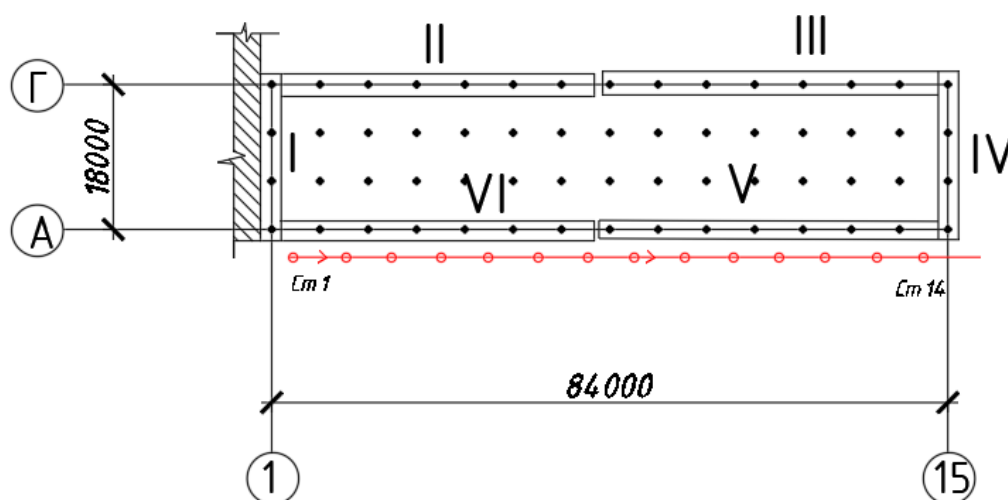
Разбивка на захваты монтажа стеновых панелей и фундаментных балок административного здания.
